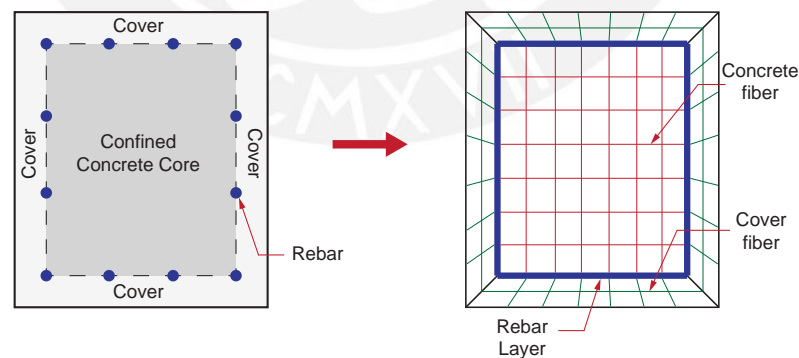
Distribución de materiales para las secciones tipo fibra de concreto armado
